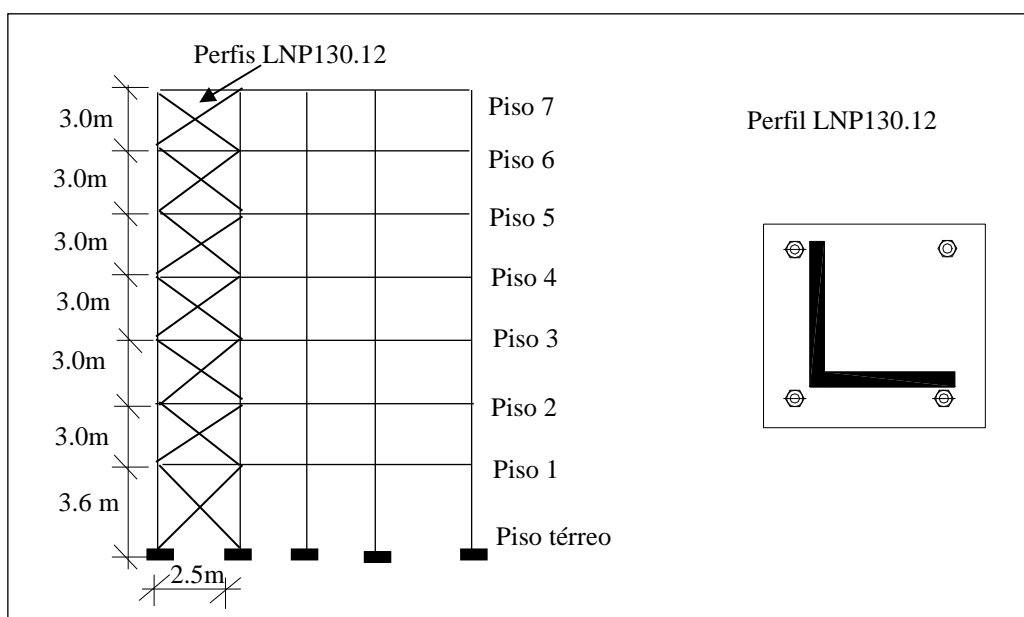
Pormenorização da solução de reforço com contraventamentos metálicos.
